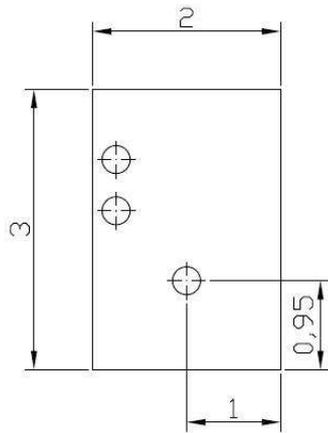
Distribución en planta de las luminarias de los baños 1 y 2.
